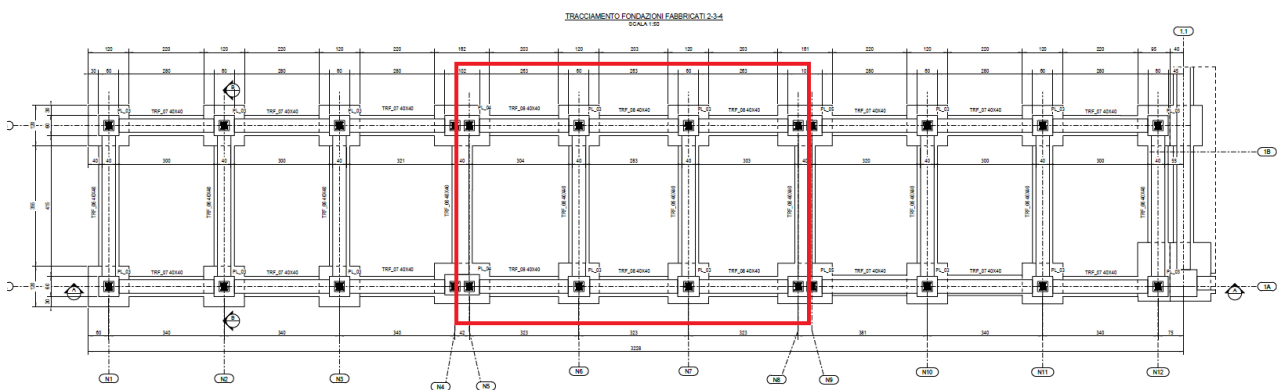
Ex Galoppatoio – pianta delle fondazioni Fabbricato 3
